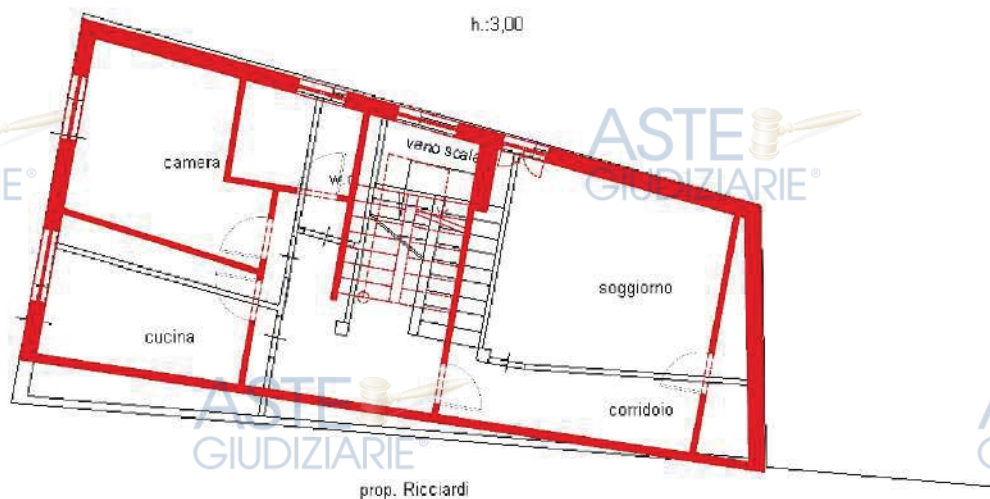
Sovrapposizione planimetria catastali su rilievo stato di fatto (in rosso) - Lotto unico
